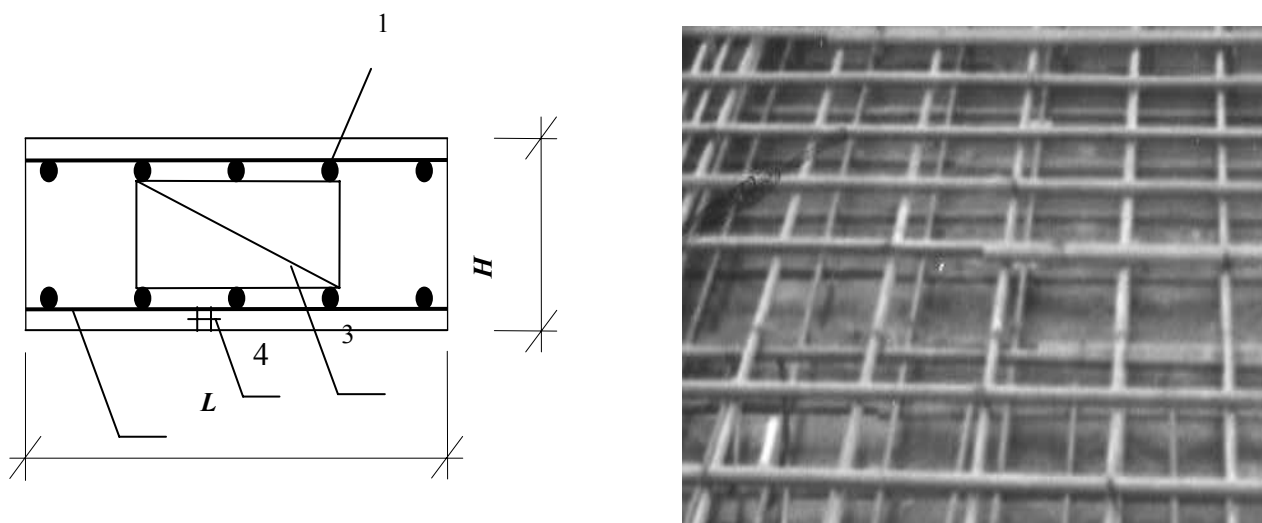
Сплошные плоские плиты перекрытий (KP1).
